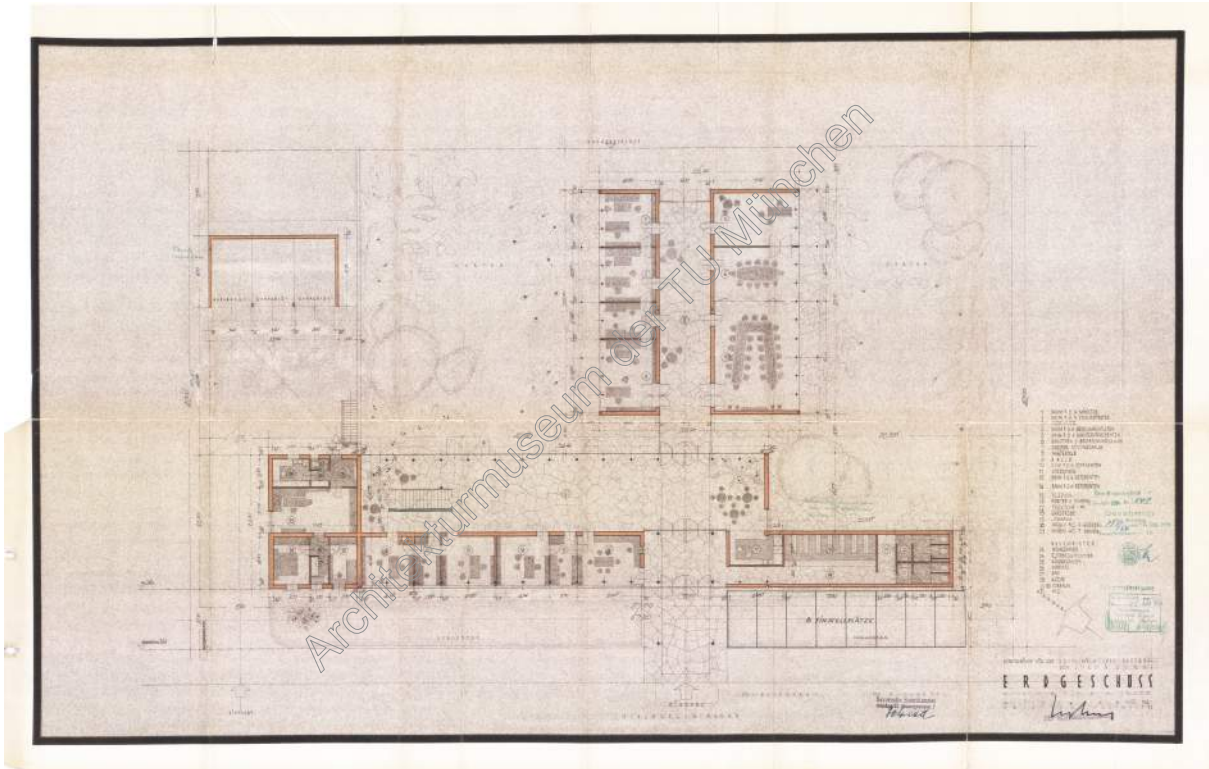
Bauantragsplanung, Grundriss Erdgeschoss. Bild: Archiv der Deutschen Stiftung Denkmalschutz.
